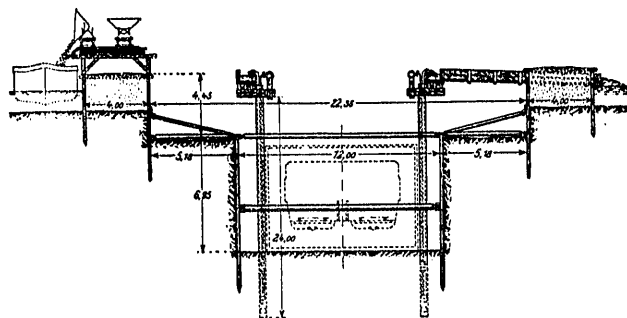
<sup>a</sup> Croquis del primer ensayo de cimentación por rebajamiento del nivel de la capa acuífera ejecutado por la Casa Siemens & Halske en la construcción del metropolitano de Berlín.
